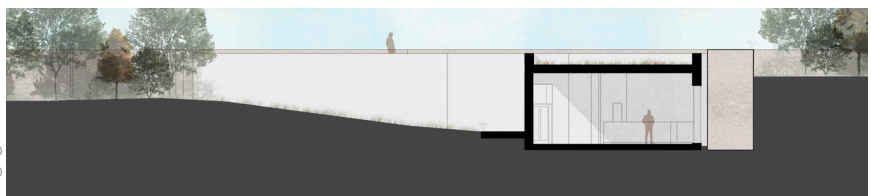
(em baixo) Modelação do terreno adjacente ao restaurante. Corte elaborado pela autora. 2018.
